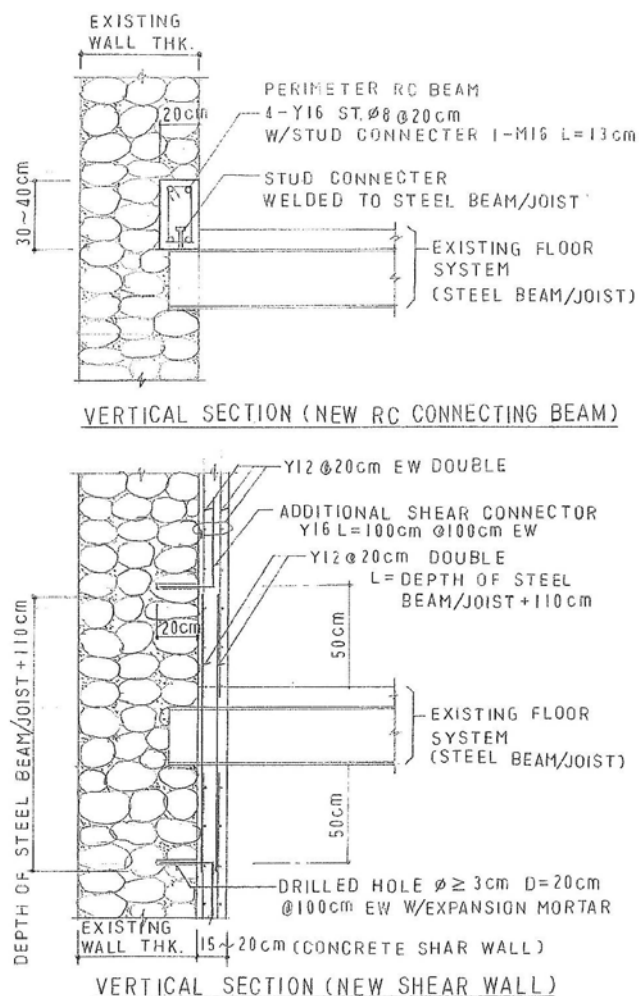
Détails typiques des nouvelles poutres de raccordement en BA et des nouveaux murs de cisaillement en BA
